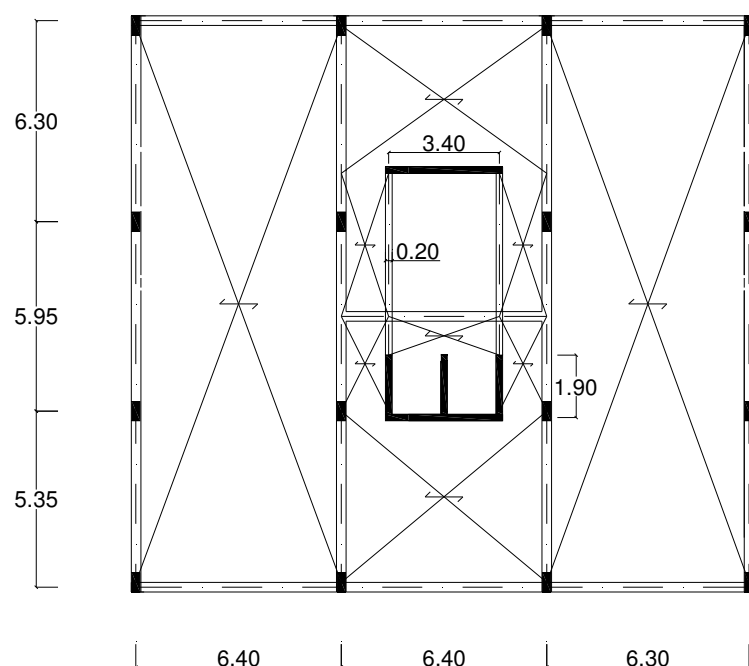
Planta estrutural de um piso superior com indicação do funcionamento das lajes
